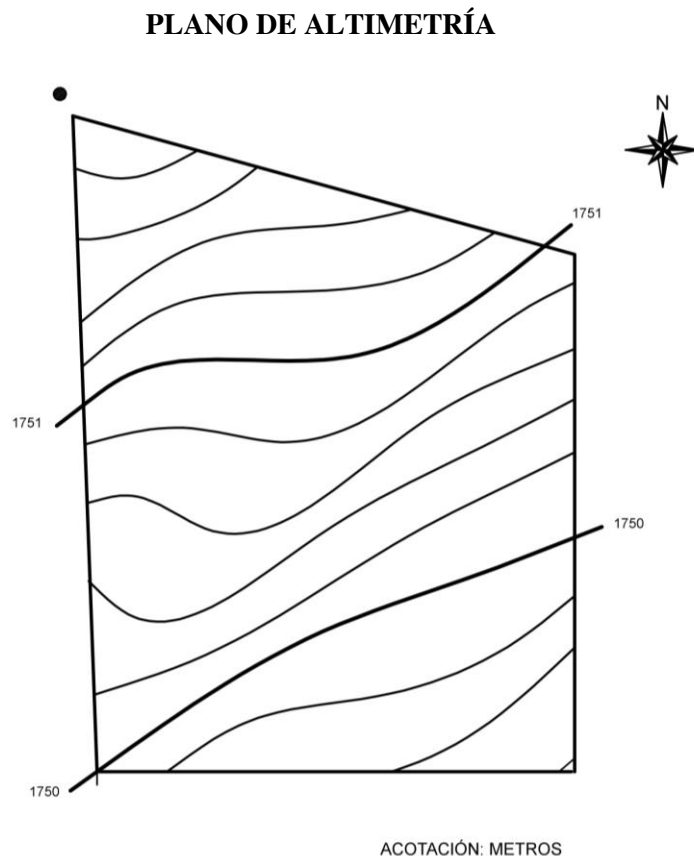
Plano de altimetría. Fuente: Elaboración propia
